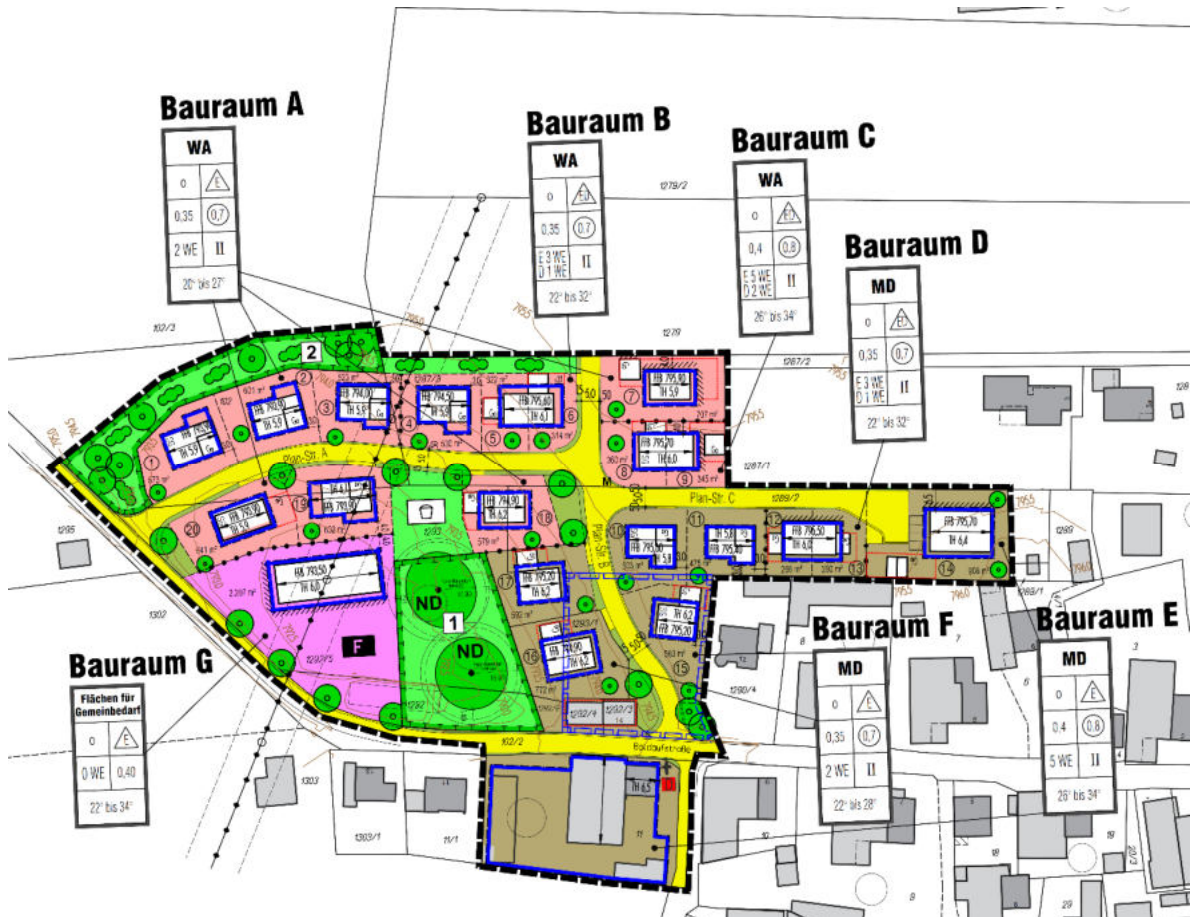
Planzeichnung, Bebauungsplan Nr. 73 „Sulzschneid-Nordwest“
